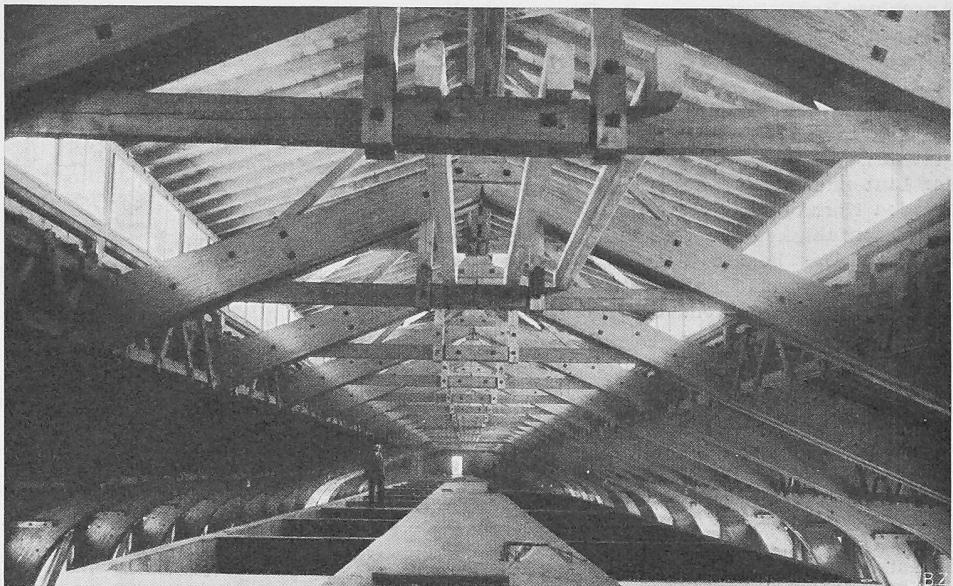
Oberlicht über den Silozellen, vor dem Einbau der Förderanlagen
